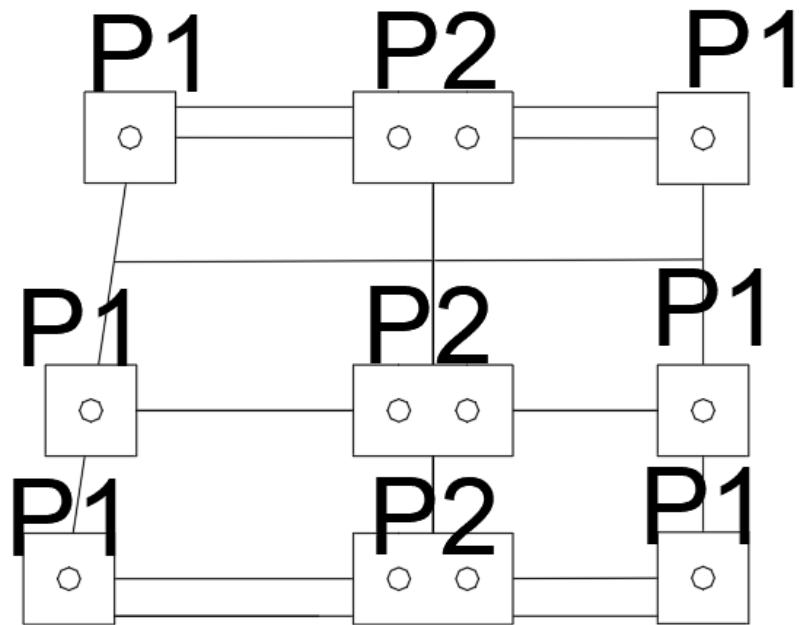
Denah *Final Pondasi* Bangunan B.1
